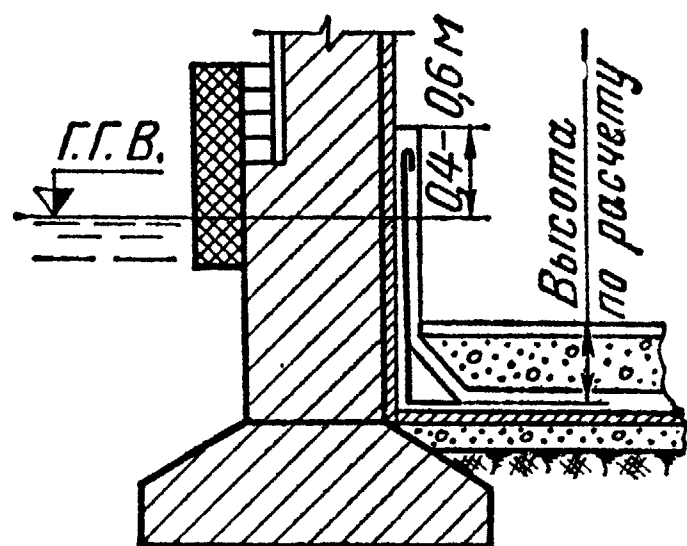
Устройство гидроизоляции при h_n до 1,25 м
